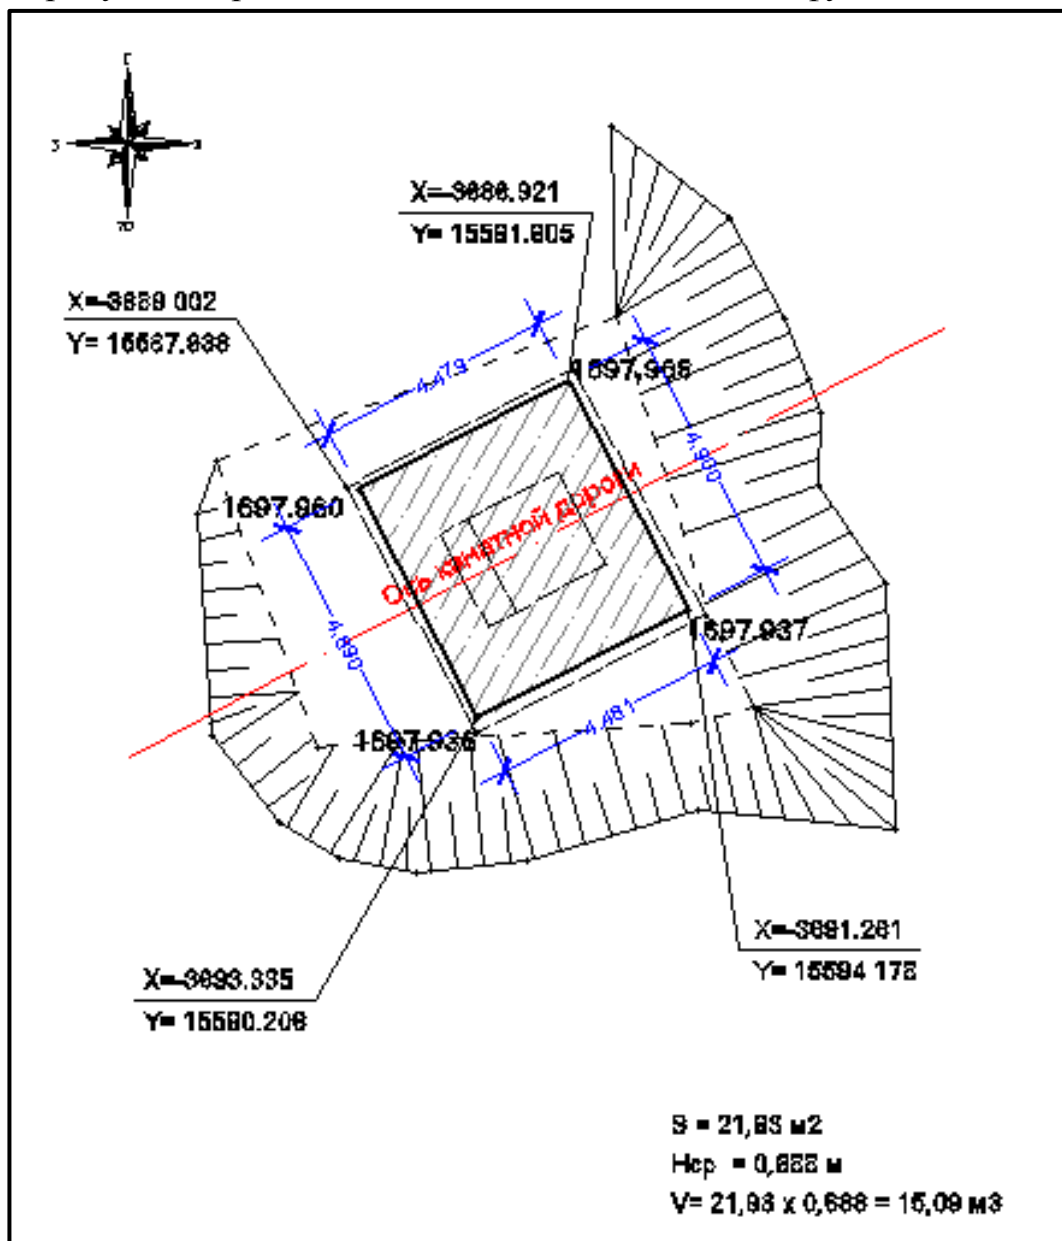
Исполнительная схема фундамента 4 опоры
